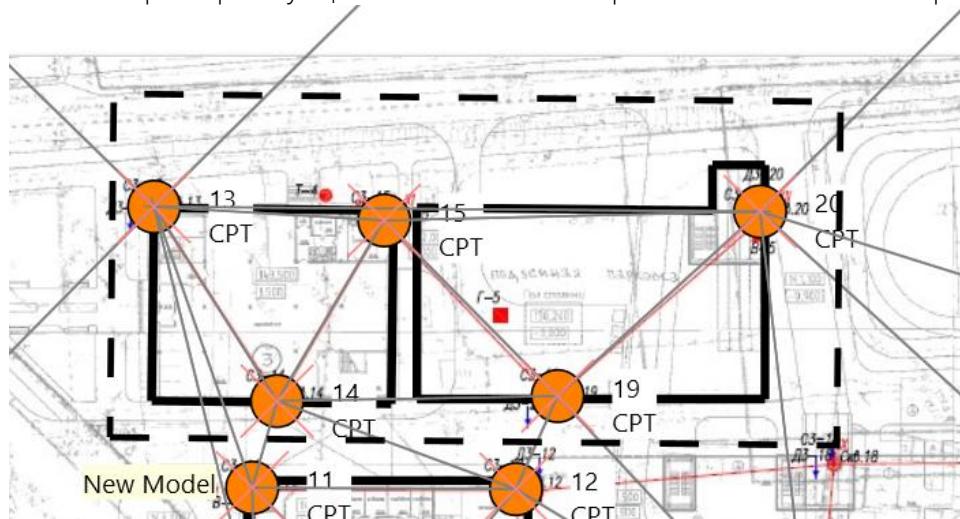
Ситуационный план площадки исследований с размещением выработок и проектируемых зданий
